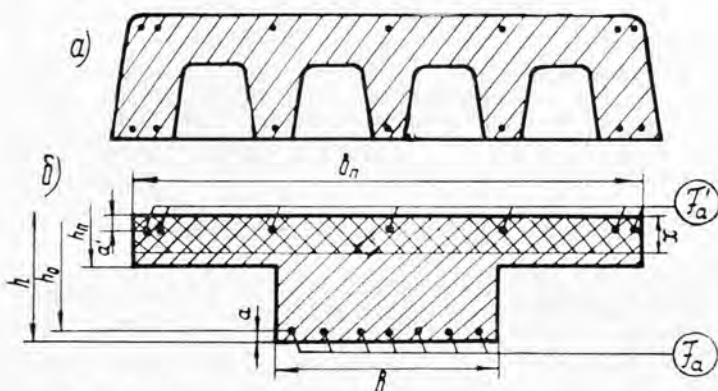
Схема поперечного сечения — а и расчетного поперечного сечения — б железобетонной плиты.
